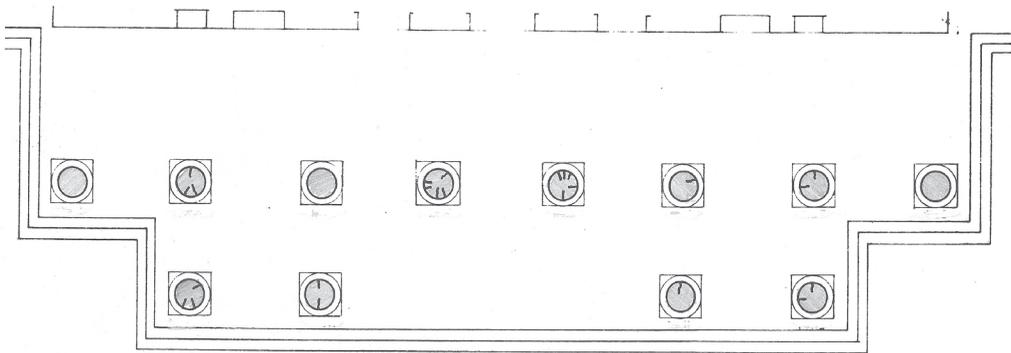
Planimetría atribuida por Esmirna Barrientos. Planta del pórtico del teatro de la ciudad de Quetzaltenango. 1995. Tesis de maestría de la Facultad de Arquitectura, USAC.
